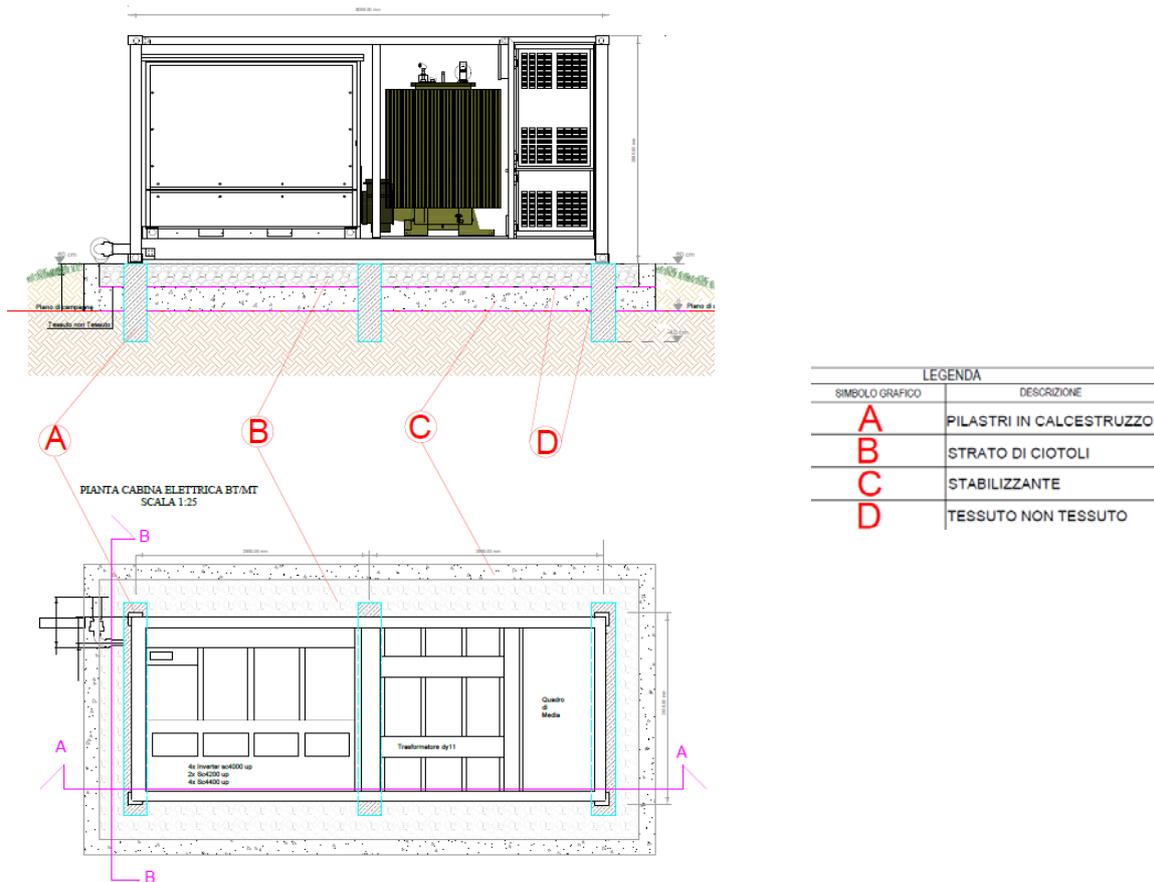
Pianta e prospetto cabina di trasformazione bt/MT
